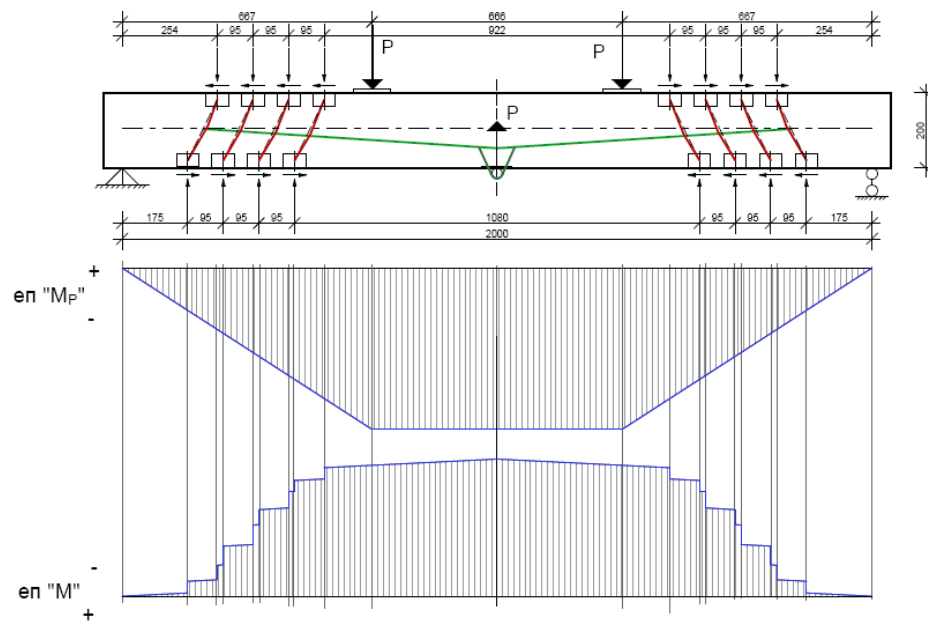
Регульовано напружена залізобетонна балка (варіант №1)
